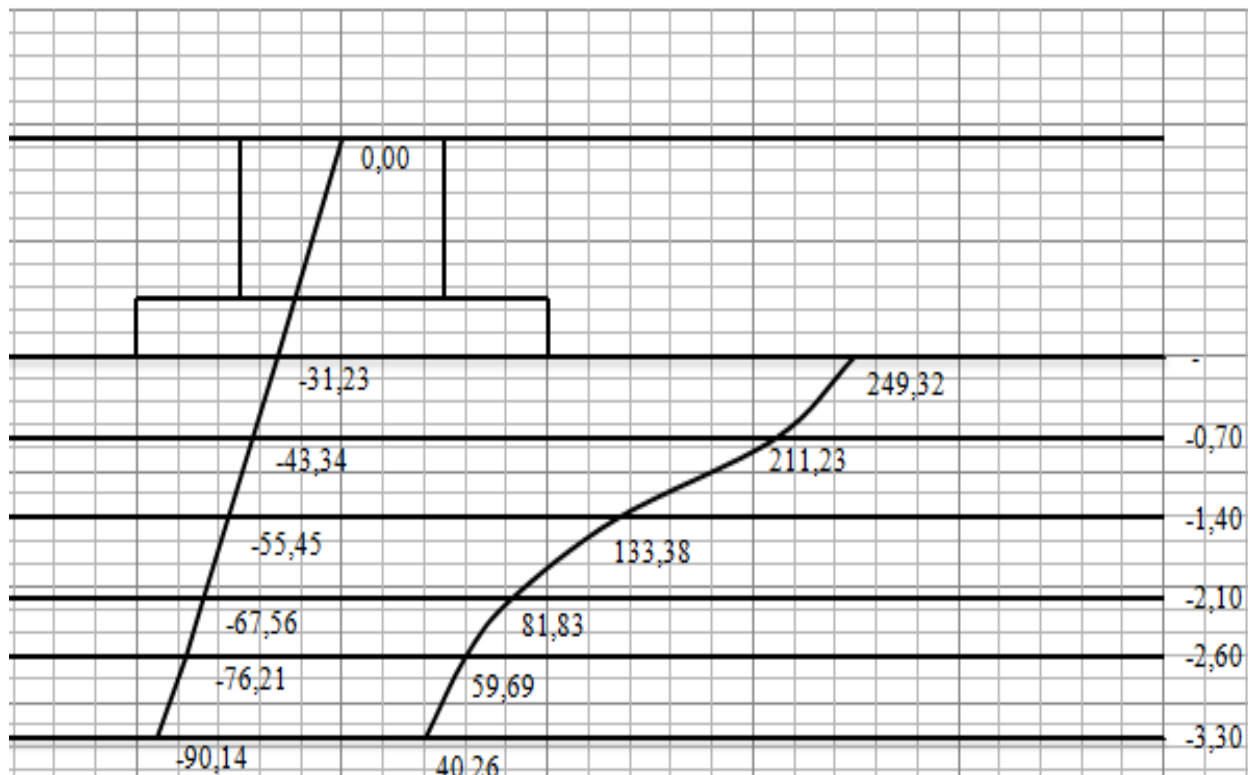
Распределение напряжений под подошвой фундамента
